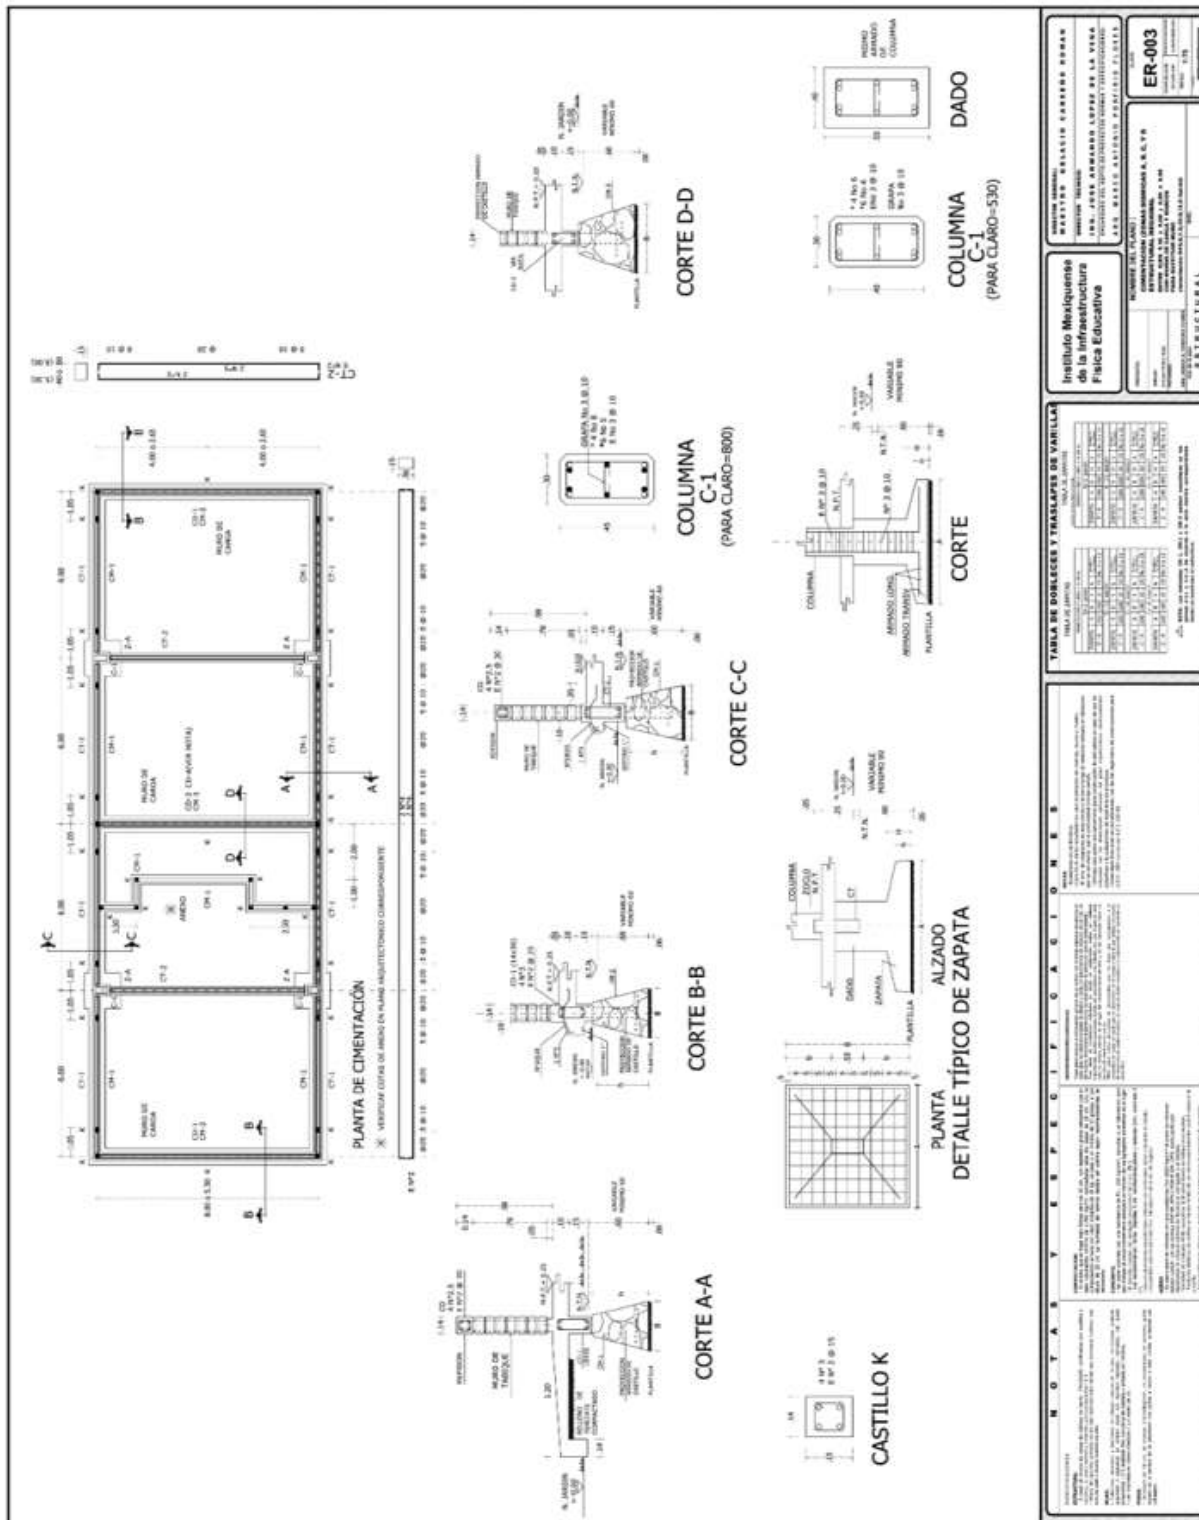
Detalle Plano de cimentación primaria Vicente Guerrero.
